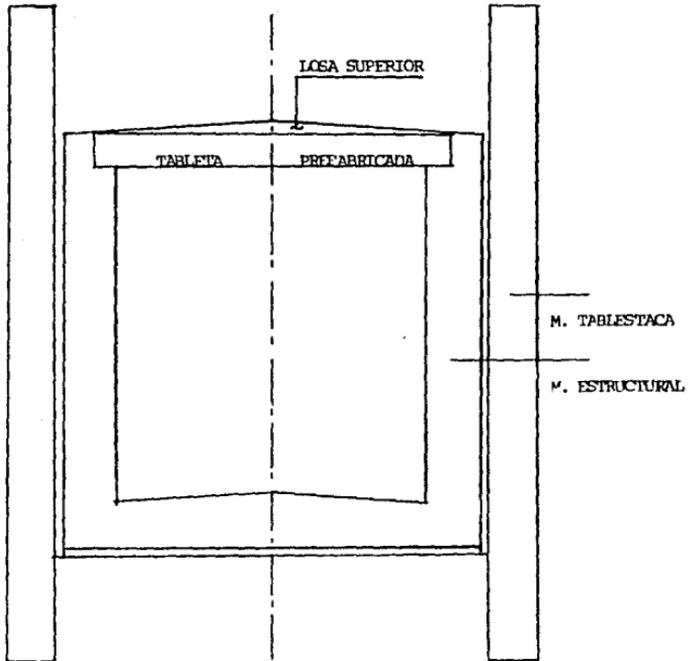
LOZA SUPERIOR EN CAJÓN NORMAL.
